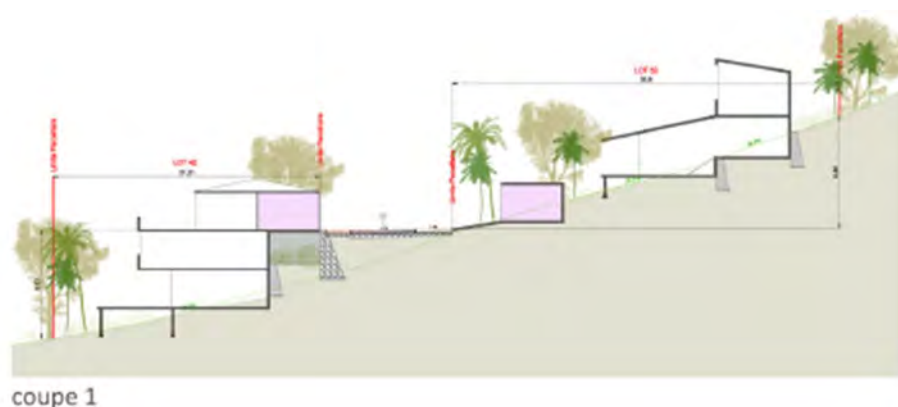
Exemple de coupe d'intégration des constructions dans la pente (Source: Atelier LD)
